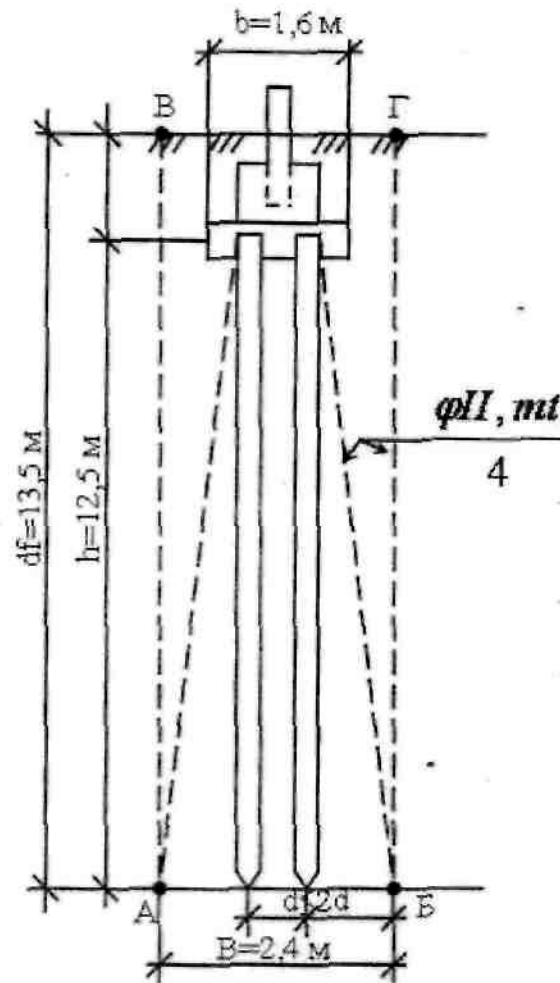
Визначення меж умовного фундаменту при розрахунку осадок палевих фундаментів
